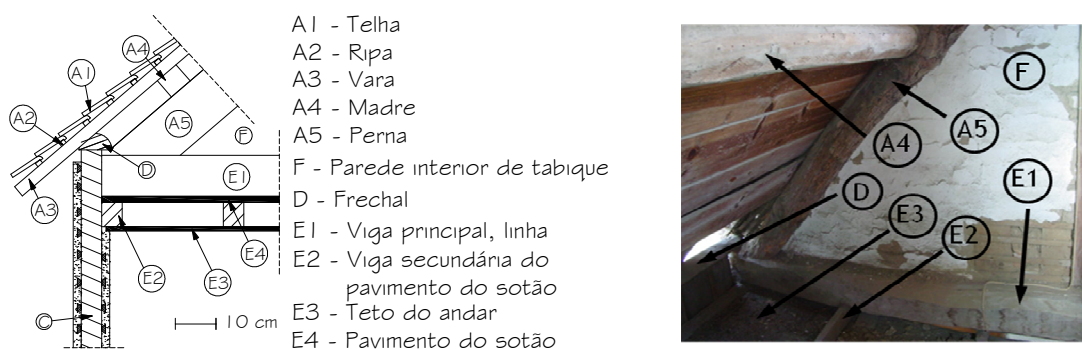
Pormenor construtivo da ligação da estrutura da cobertura à parede exterior e ao pavimento, detalhe IV
